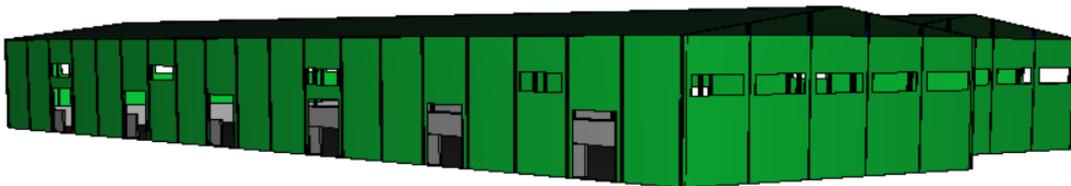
Secondo prospetto del capannone eseguito con PyroSim
